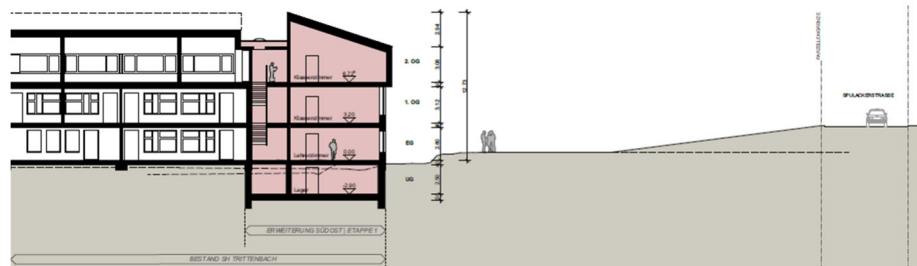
Disposition 1.2 | Gebäudeschnitt B-B
